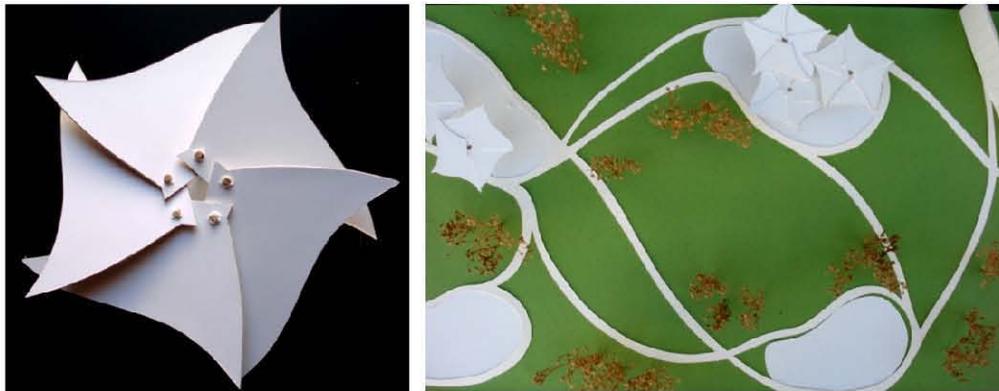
Constructo en planta de la propuesta de la cubierta
